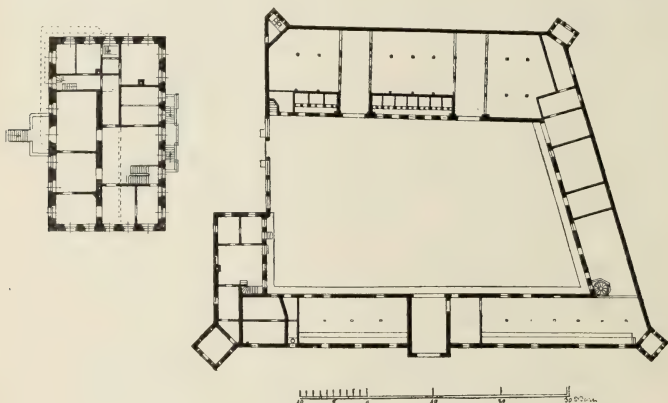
Gleuel. Horbell, Grundriss.
